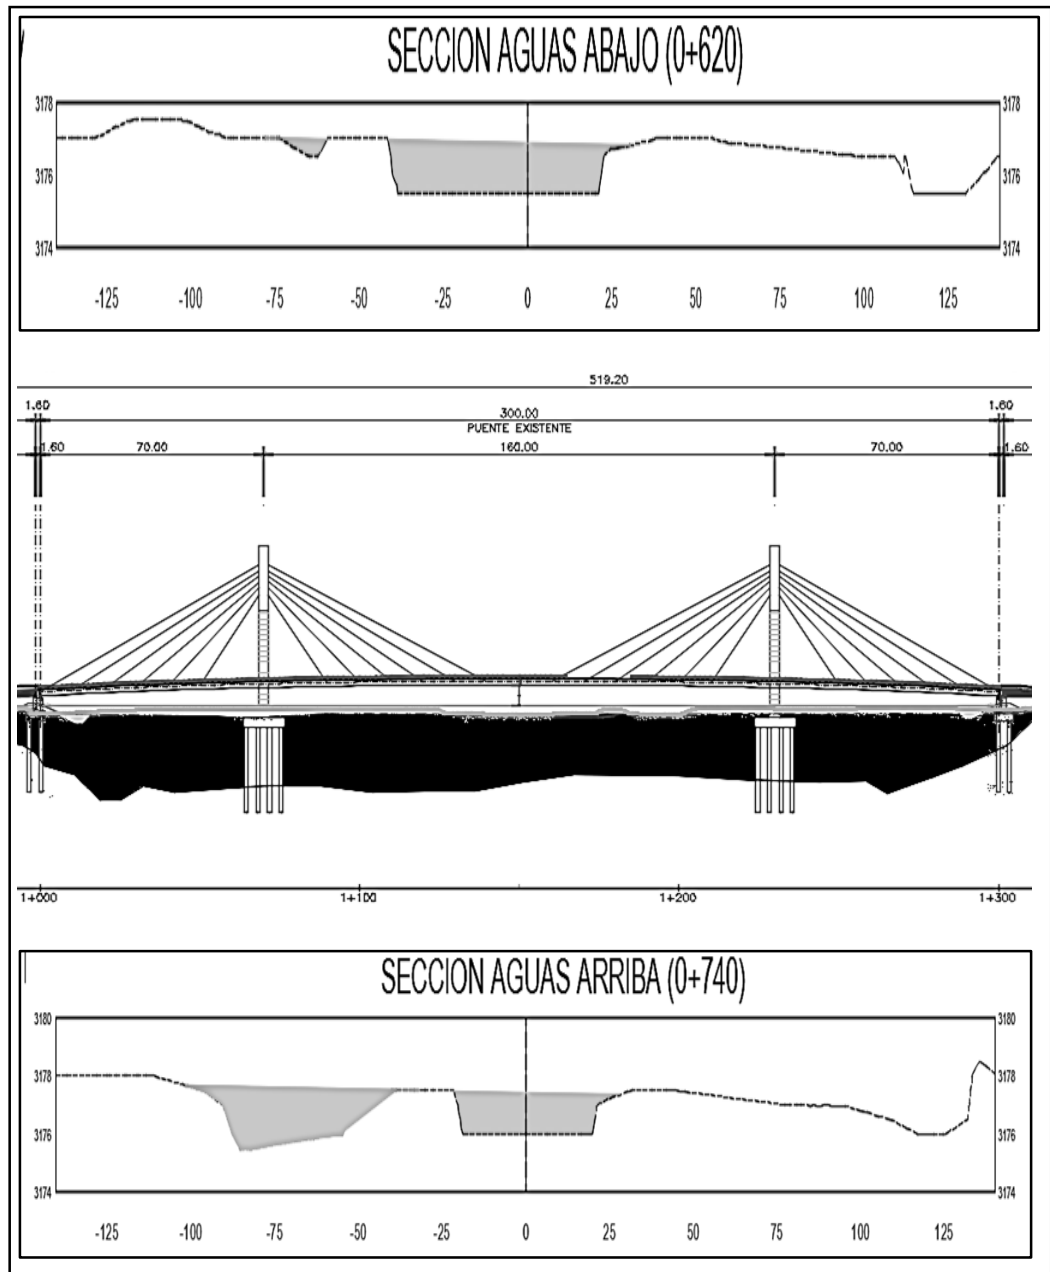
Secciones interpoladas AutoCAD civil 3D.
